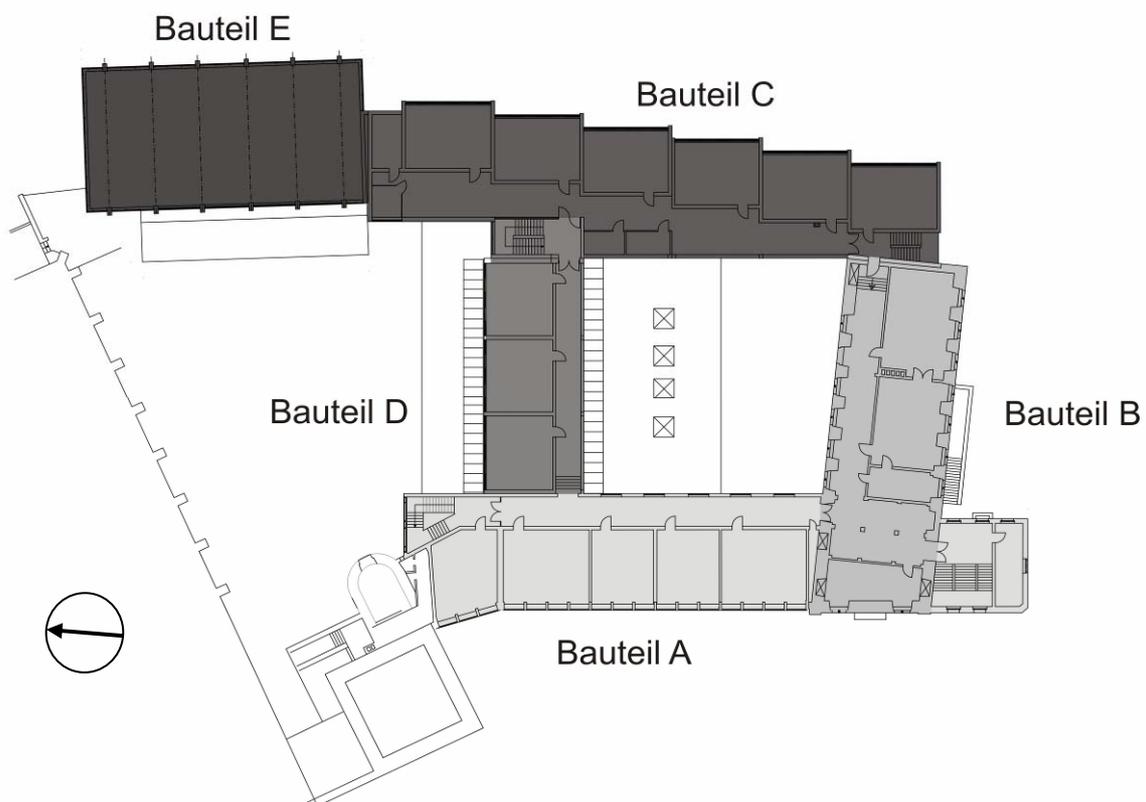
Grundriss 1.OG Gymnasium Josephinum in Hildesheim
